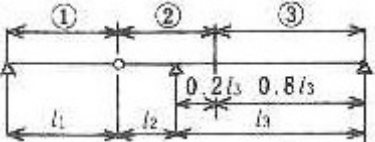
圧縮フランジの片側有効幅(主げたの場合)
